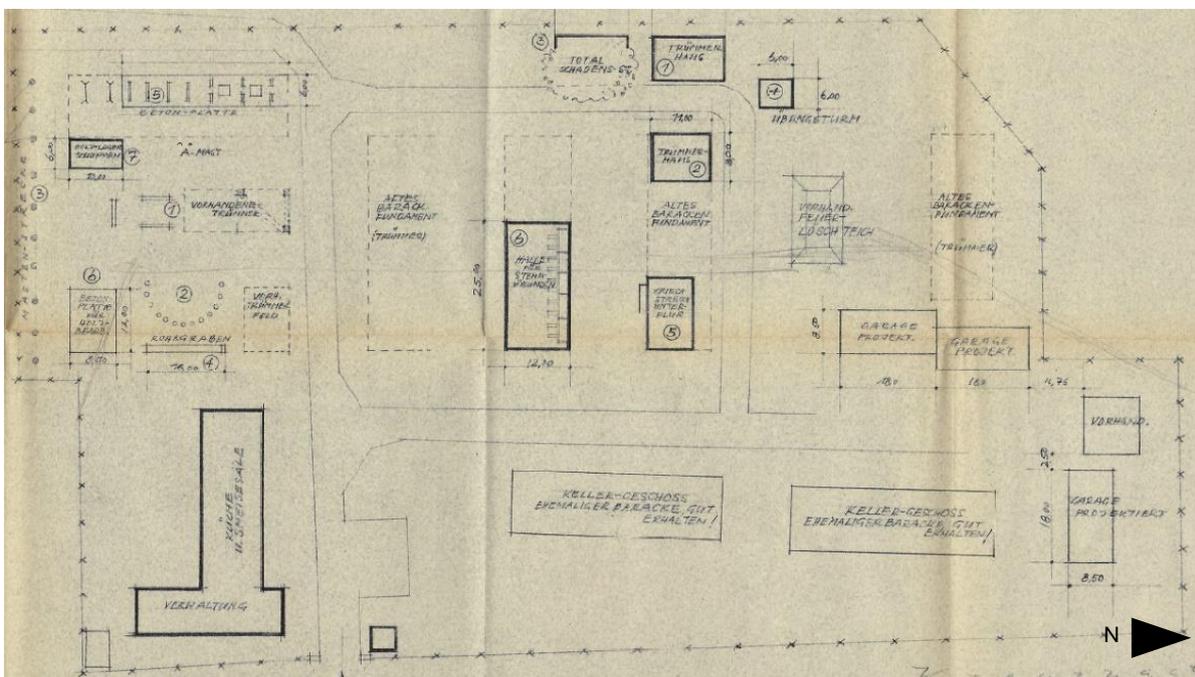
Lageplan 1959 (Stadt Bad Kreuznach)
